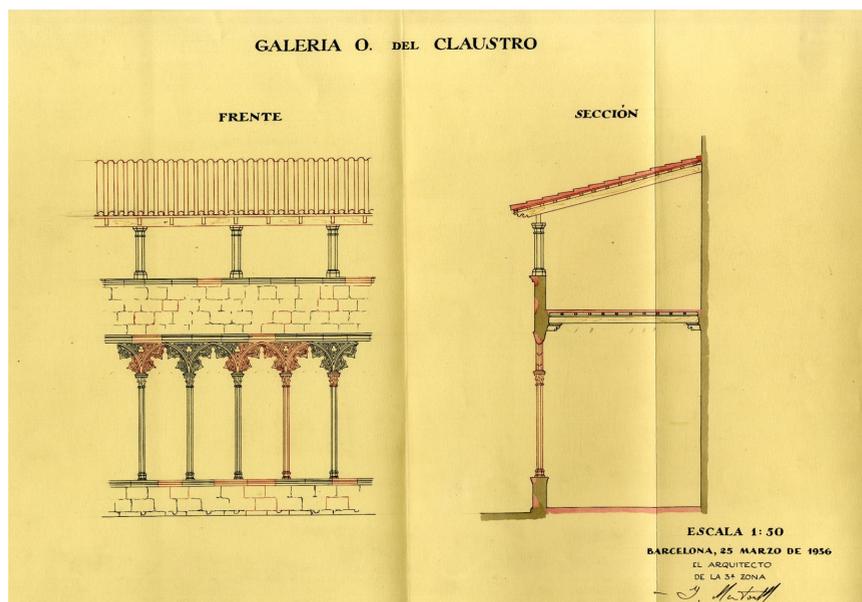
Sección y alzado de la sección Oeste de la arquería del claustro del convento de san Francisco con los elementos reintegrados en la arquería señalados en rojo.
